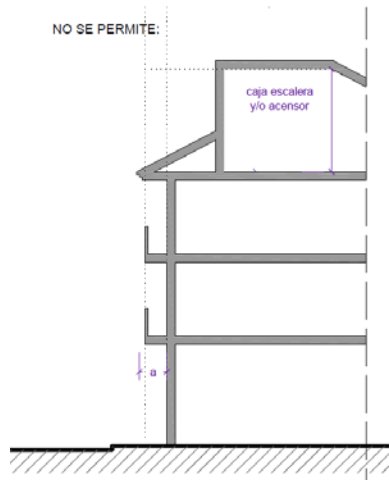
Ejemplo de sección incorrecta del faldón de cubierta.
